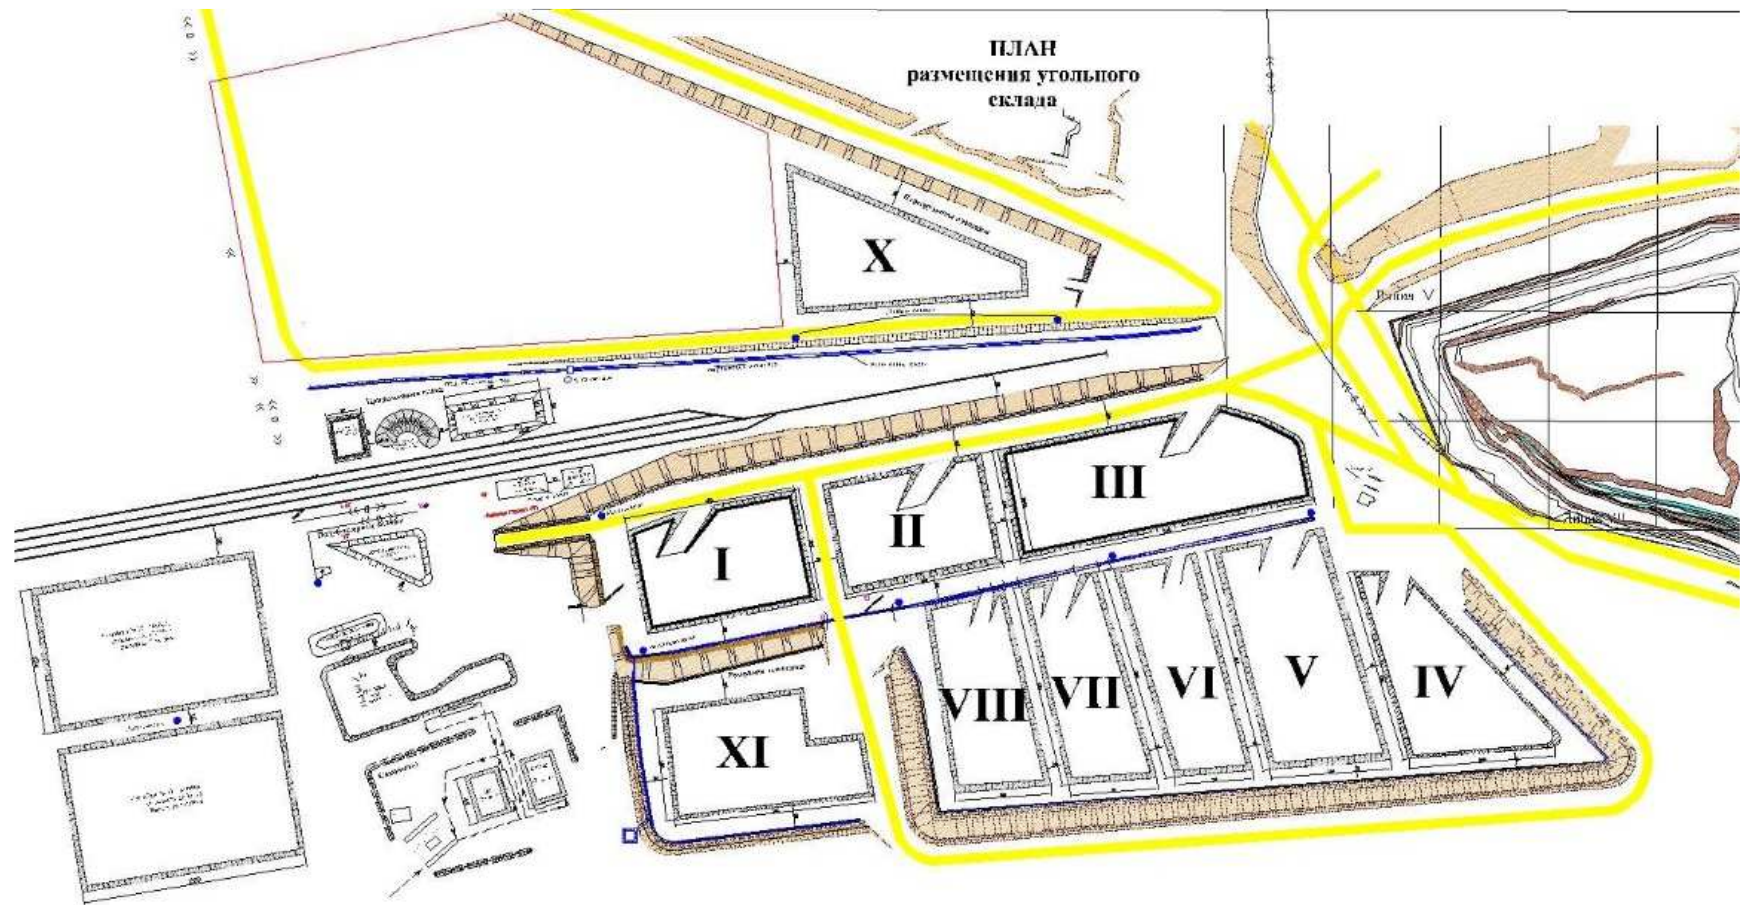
Предлагаемый план размещения угольного склада
